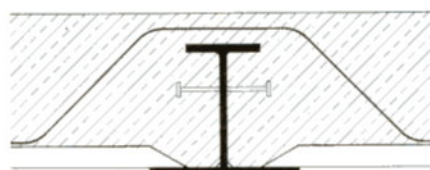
Ausführung mit Beton-Fertigteilplatten
